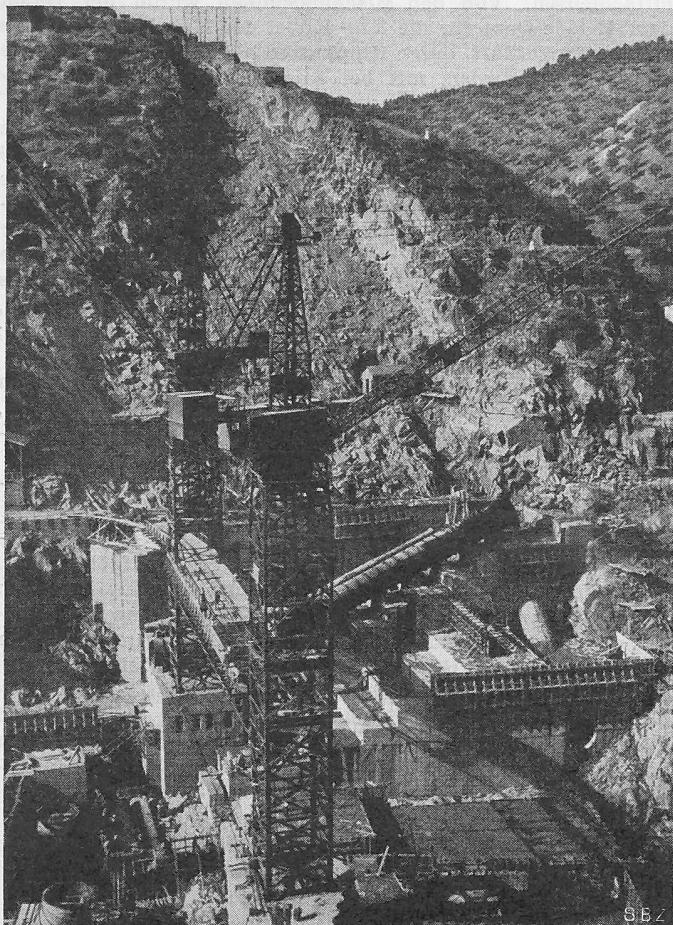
Staumauerfundament, Montage der Grundablass-Leitungen und der Saugrohre der Turbinen 2 und 3; Turmkran für 4 t Last bei 40 m, 7 t bei 35 m. 30. Sept. 1948
